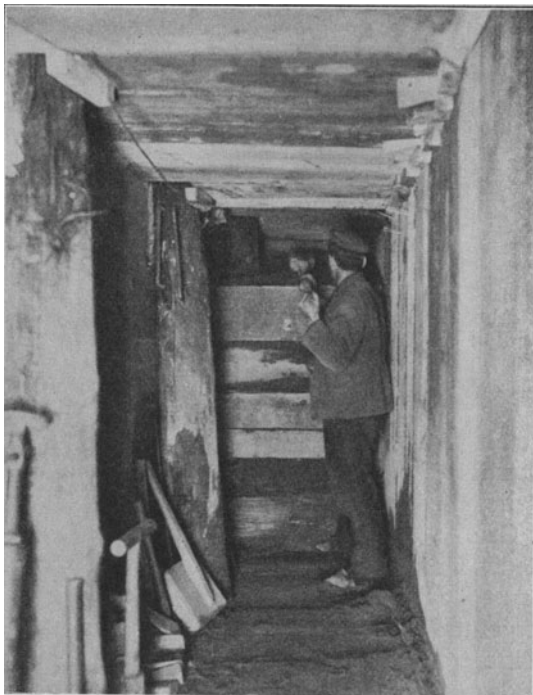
Stampfen eines Betonpfeilers bei der Unterfangung eines Hauses. (Siemens-Bau-Union.)
